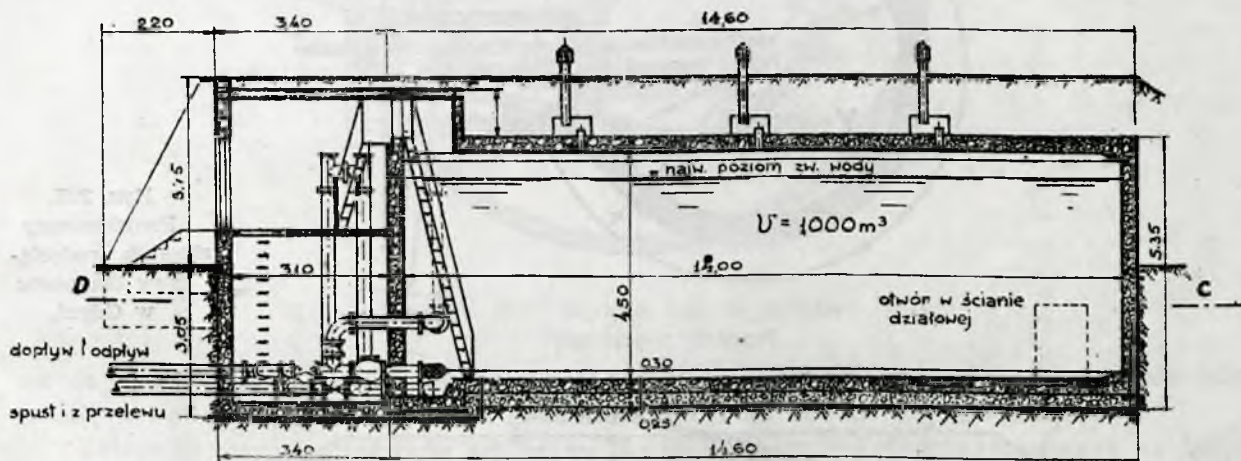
Projektowany zbiornik żelbetowy dla Krośna.
